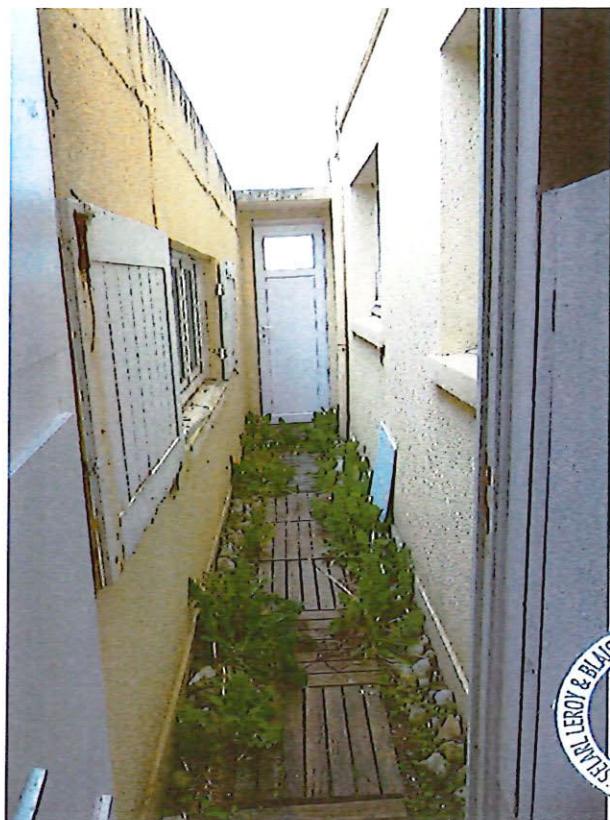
Allée sur laquelle donnent les deux fenêtres (à droite sur la photo) de la pièce principale
